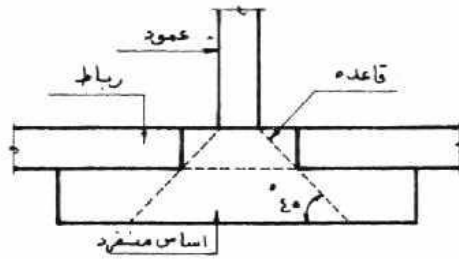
مخطط ومقطع اساس منفرد مع رباط من الخرسانة المسلحة
